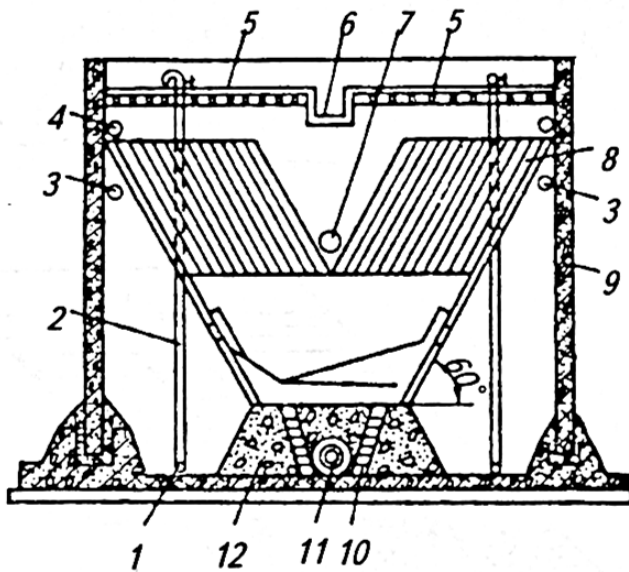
Вертикальный тонкослойный отстойник: 1 – полиэтиленовая труба для удаления осадка; 2 – труба для выпуска воздуха; 3, 7 – отвод осветленной воды из осадкоуплотнителя; 4 – трубопровод подогрева; 5 – отверстие в поперечных сборных желобах; 6 – сварной лоток; 8 – многослойная загрузка; 9 – корпус; 10 – кирпичная кладка; 11 – подвод воды в секцию; 12 – гравийная камера хлопьеобразования
